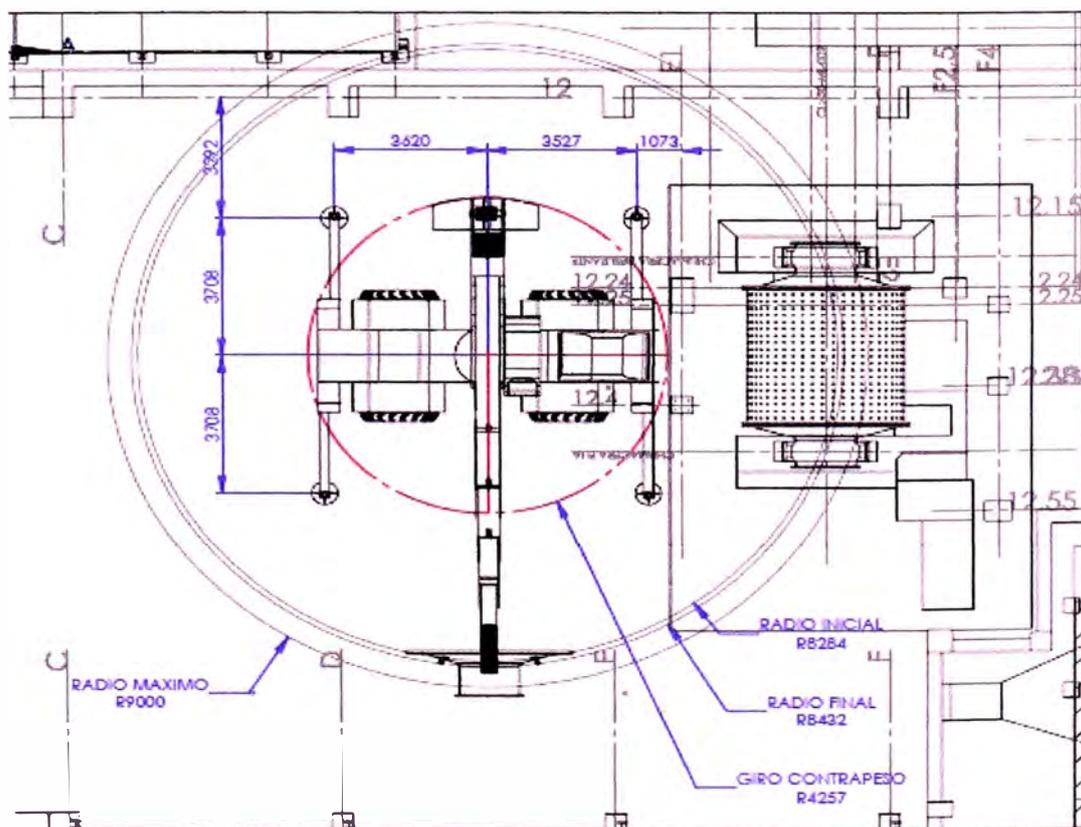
Vista de planta del rigging plan – Montaje de tapas
